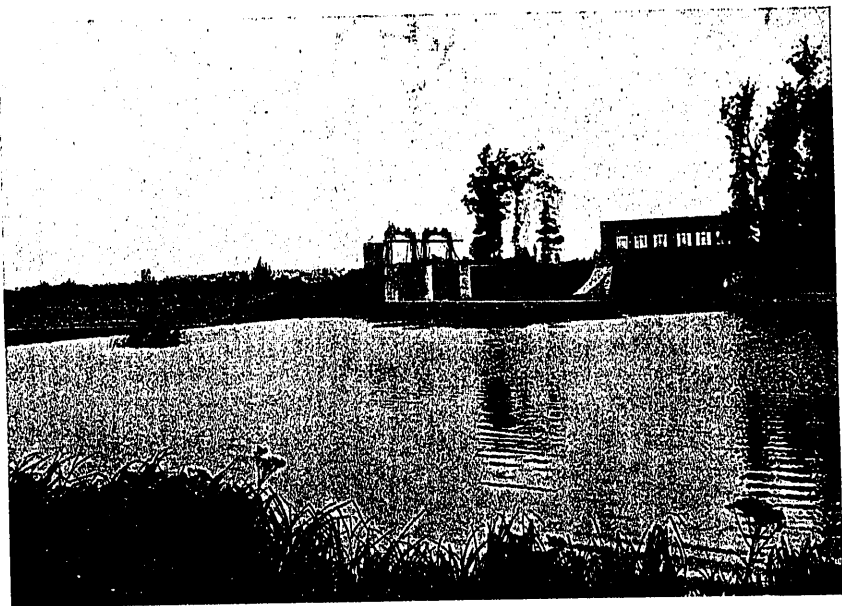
Obras de toma: canal de entrada, canal de toma y compuertas de limpia y toma
